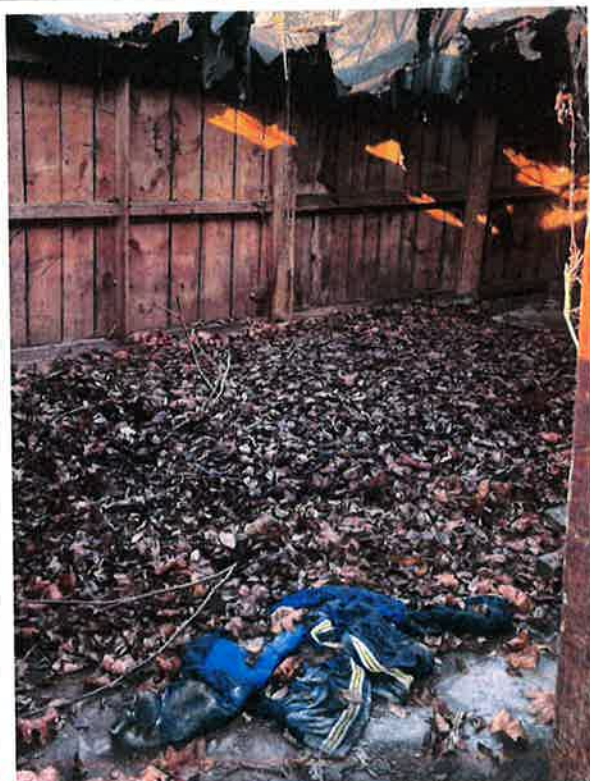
Zniszczenie konstrukcji i pokrycia dachu
